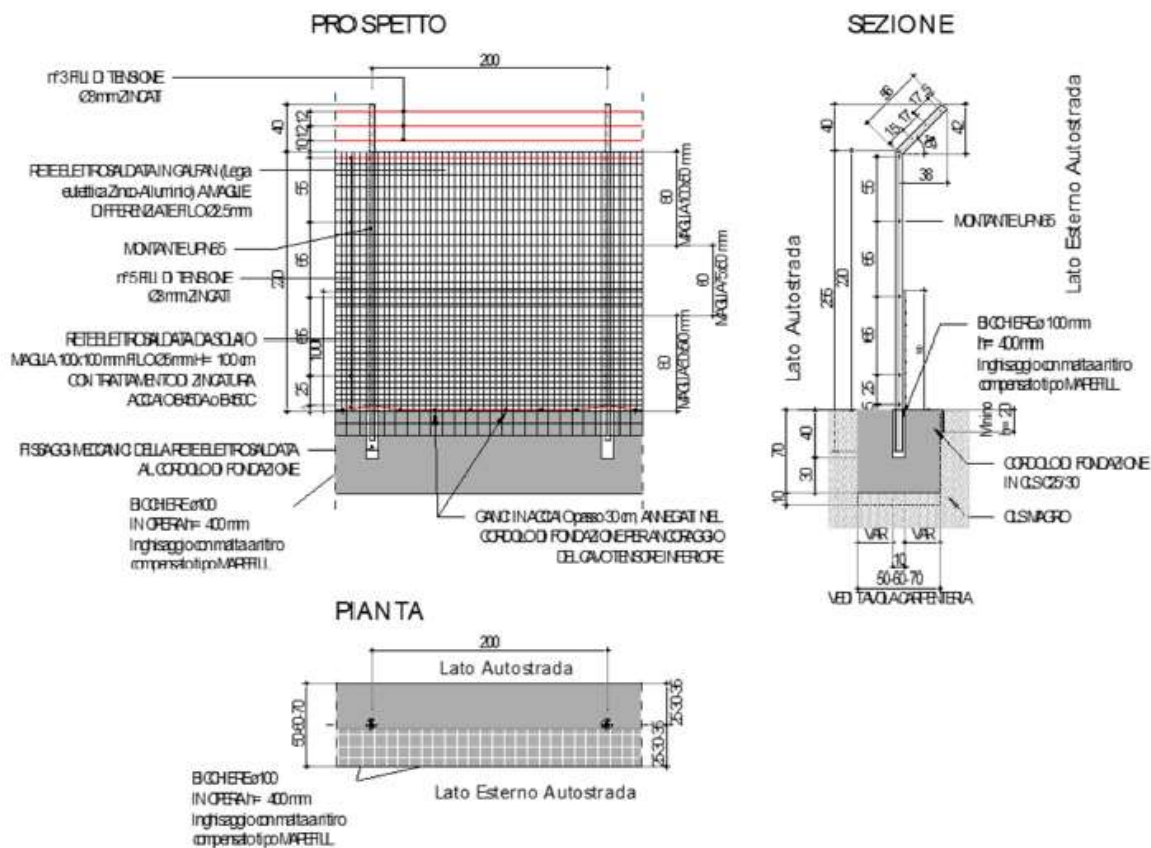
Manufatto di recinzione: tipologia corrente – sezione, vista frontale e pianta
